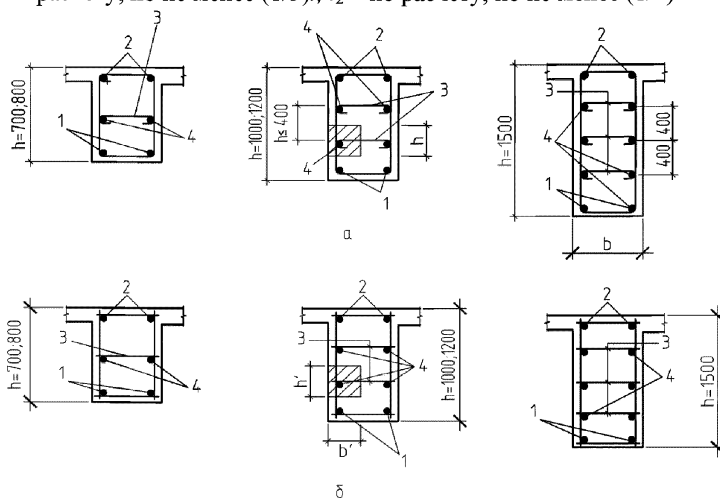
Размещение конструктивных стержней по высоте боковых граней балок при каркасах: *а* – вязаных; *б* – сварных; 1, 2 – продольная арматура соответственно опорная и монтажная; 3 – шпильки; 4 – продольный конструктивный стержень площадью поперечного сечения $A_{sc,1}$
